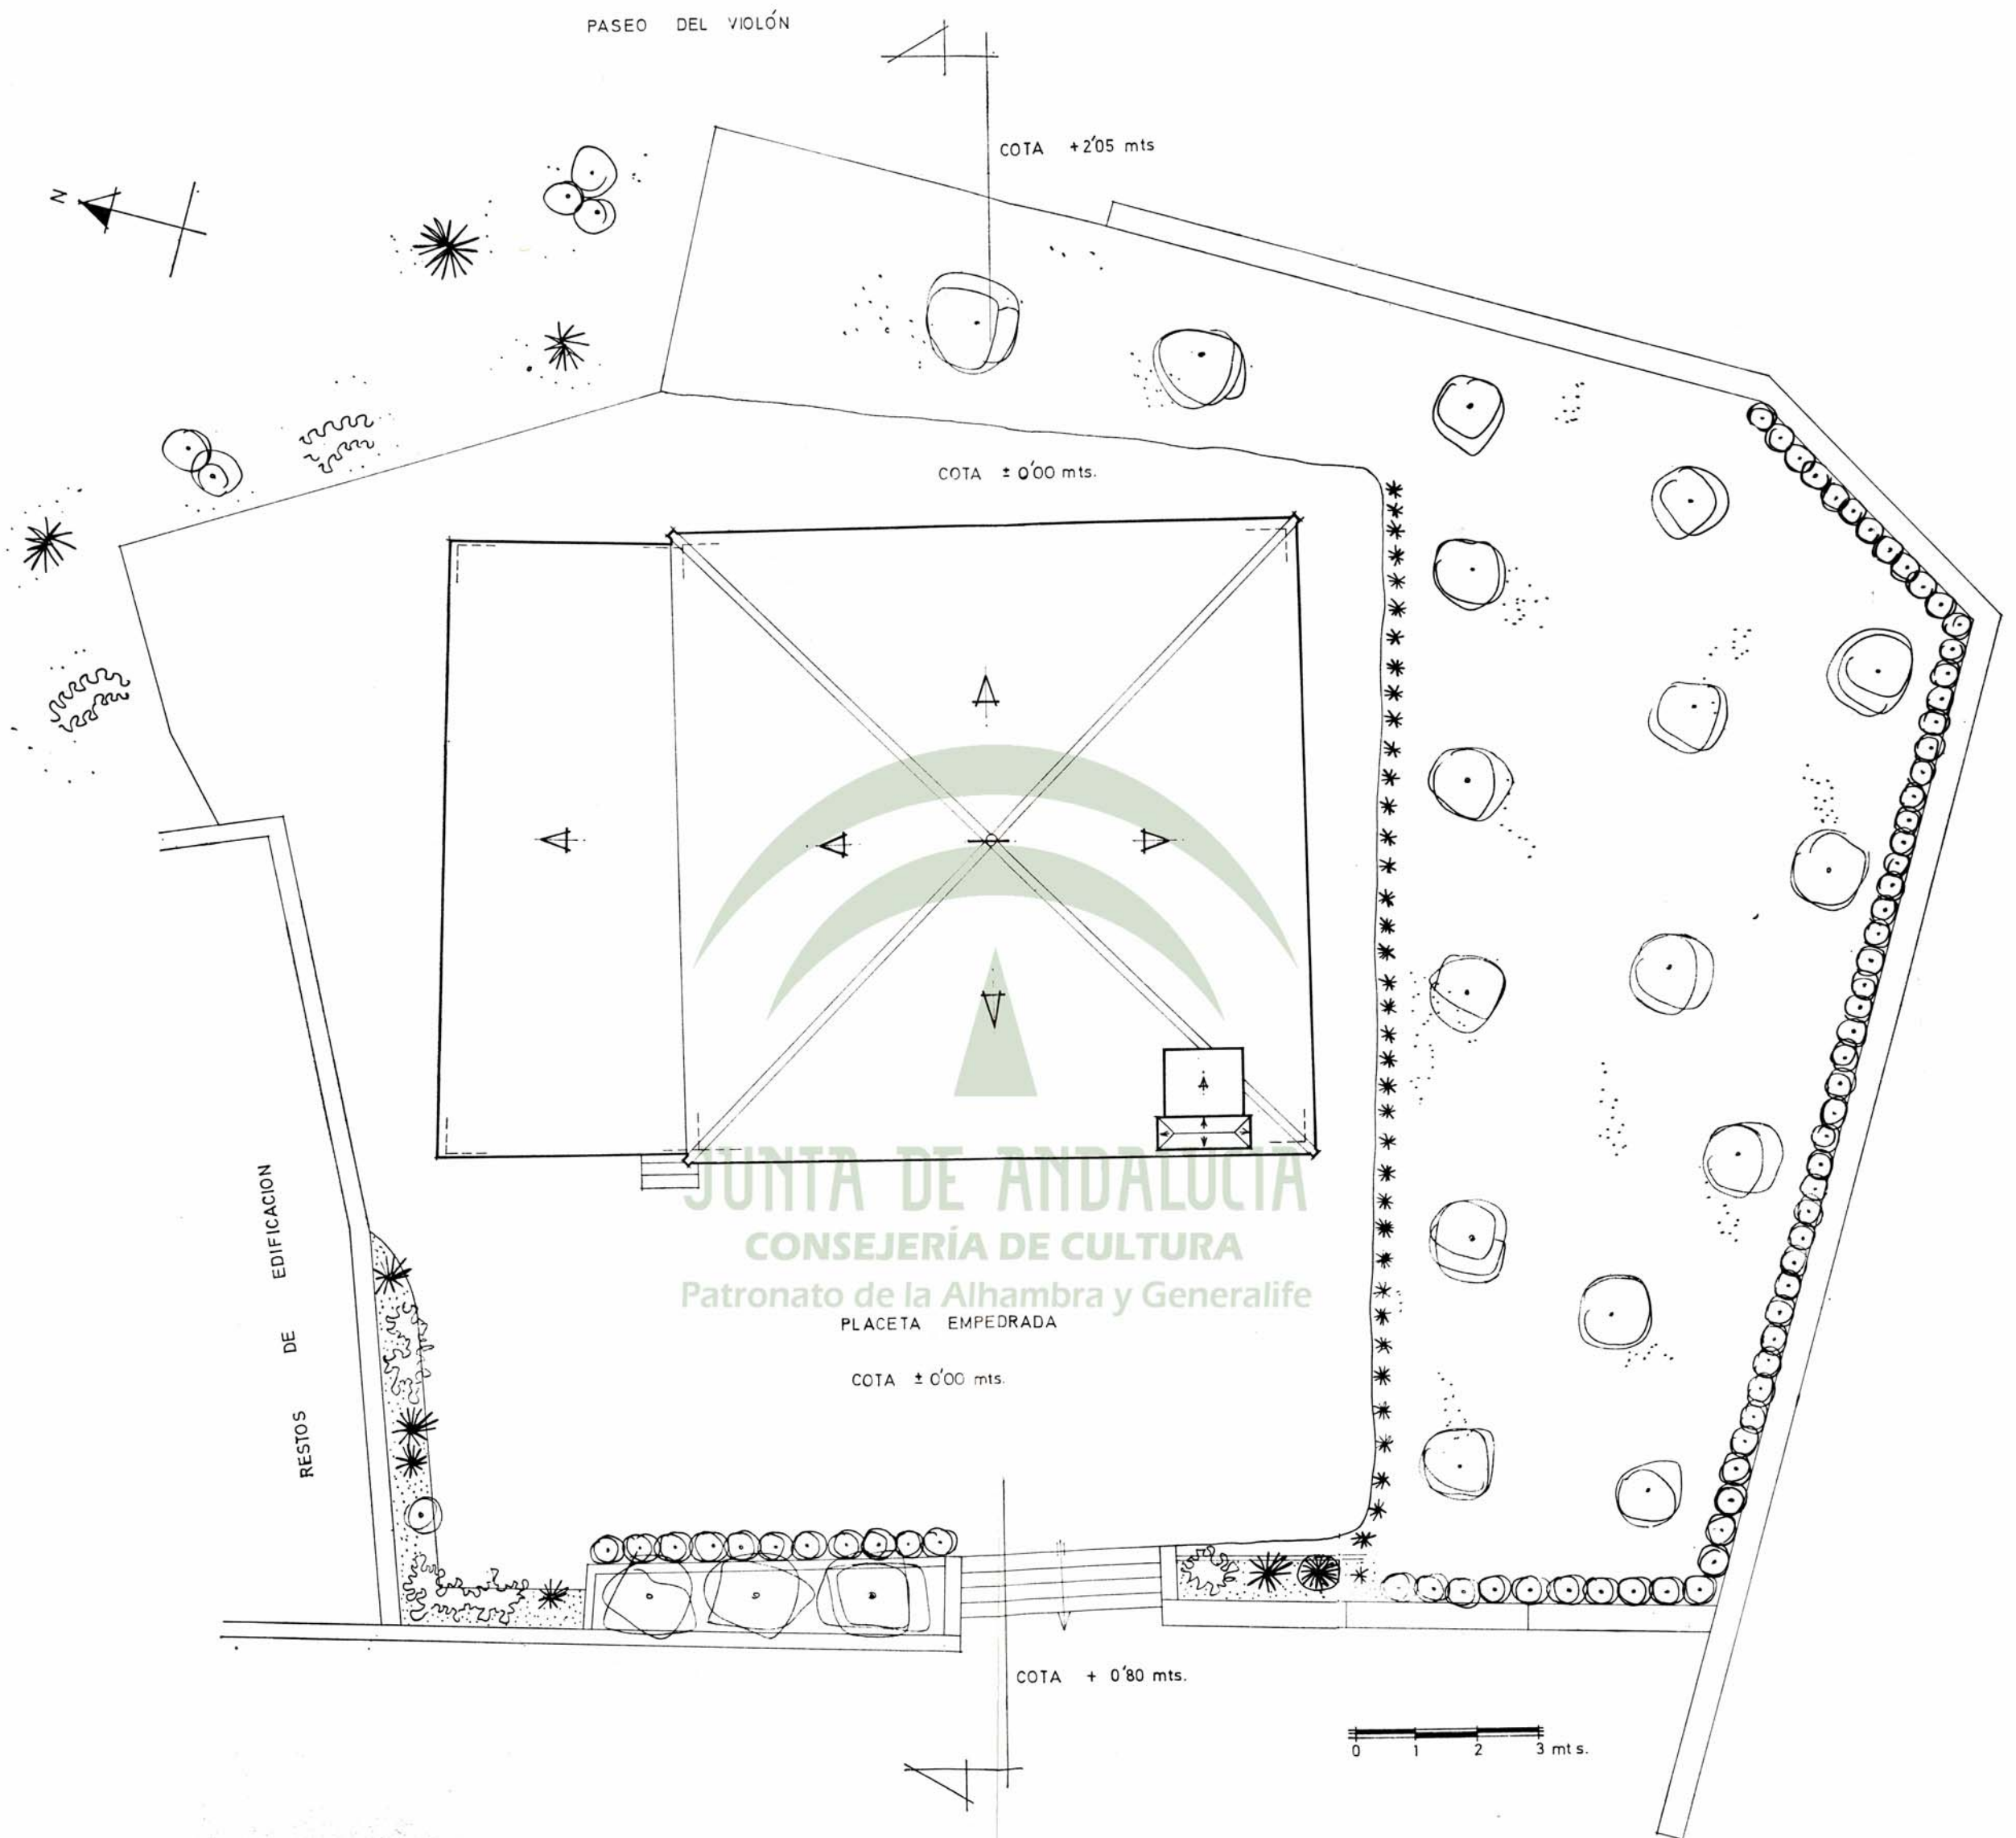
Ermita de San Sebastián. Planta general de cubiertas y jardines
